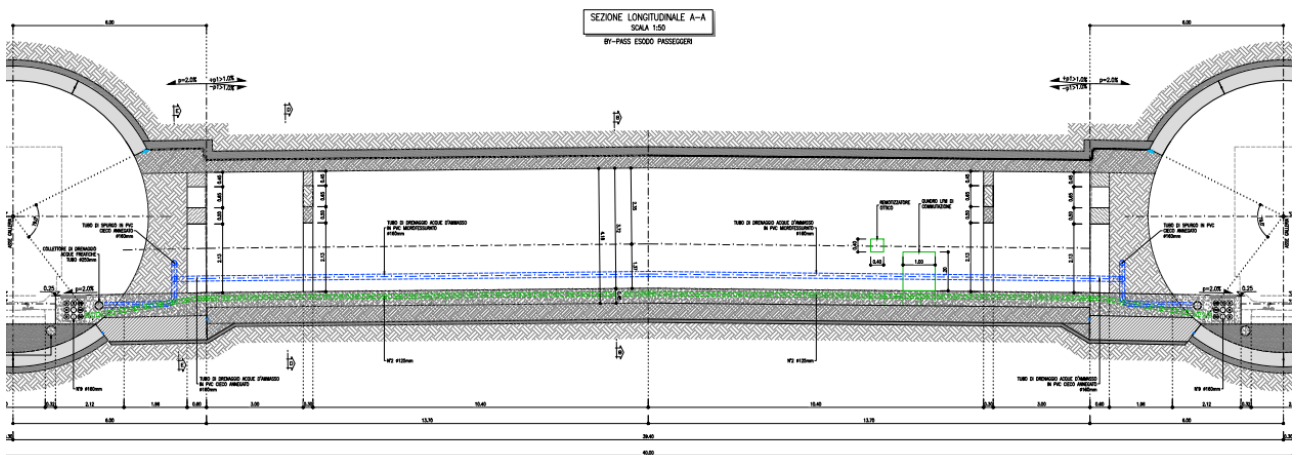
Sezione longitudinale acque di drenaggio by-pass
